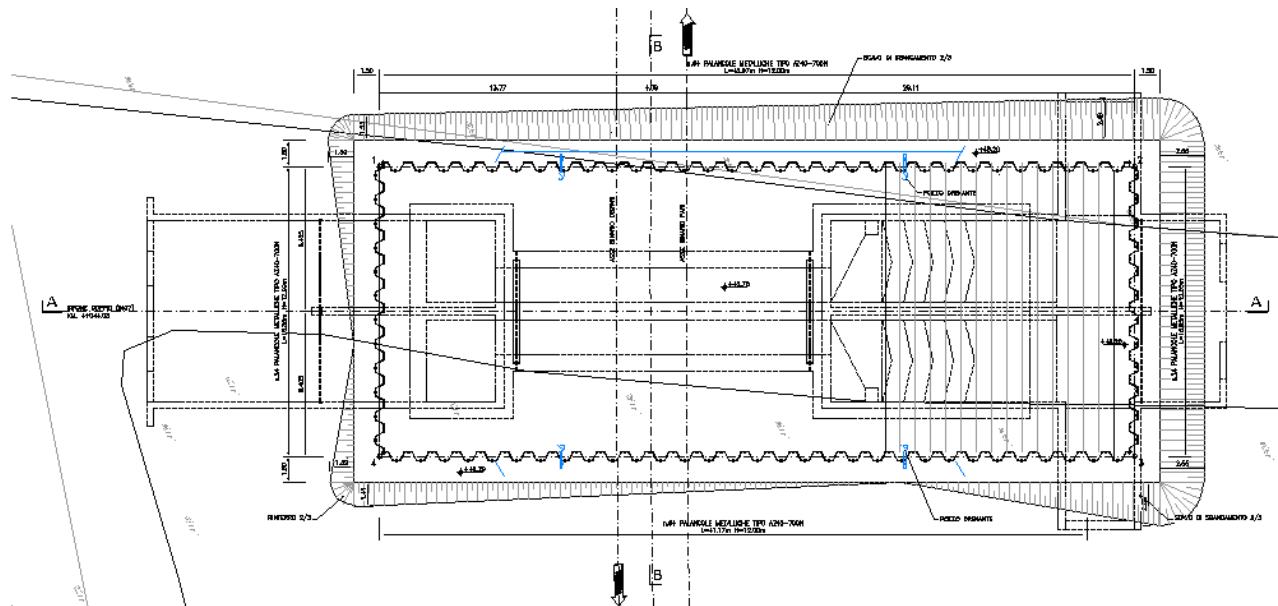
Planimetria opere provvisionali scavi in corrispondenza del sifone
